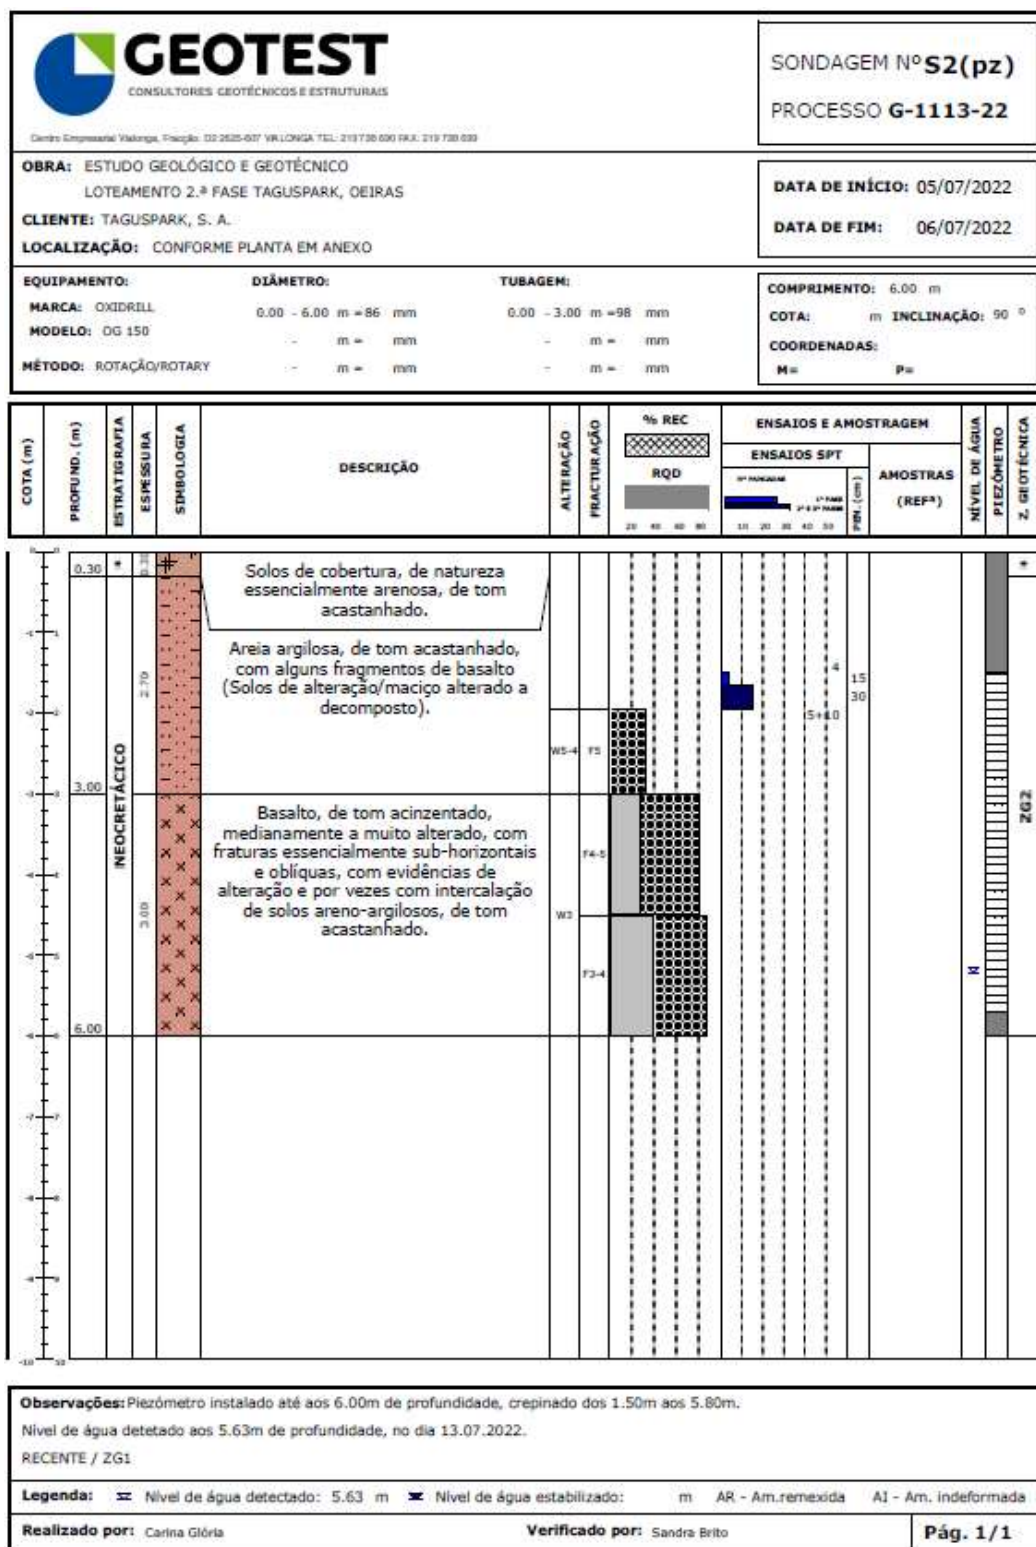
Sondagem S2 – Perfil (GEOTEST, 2022)
